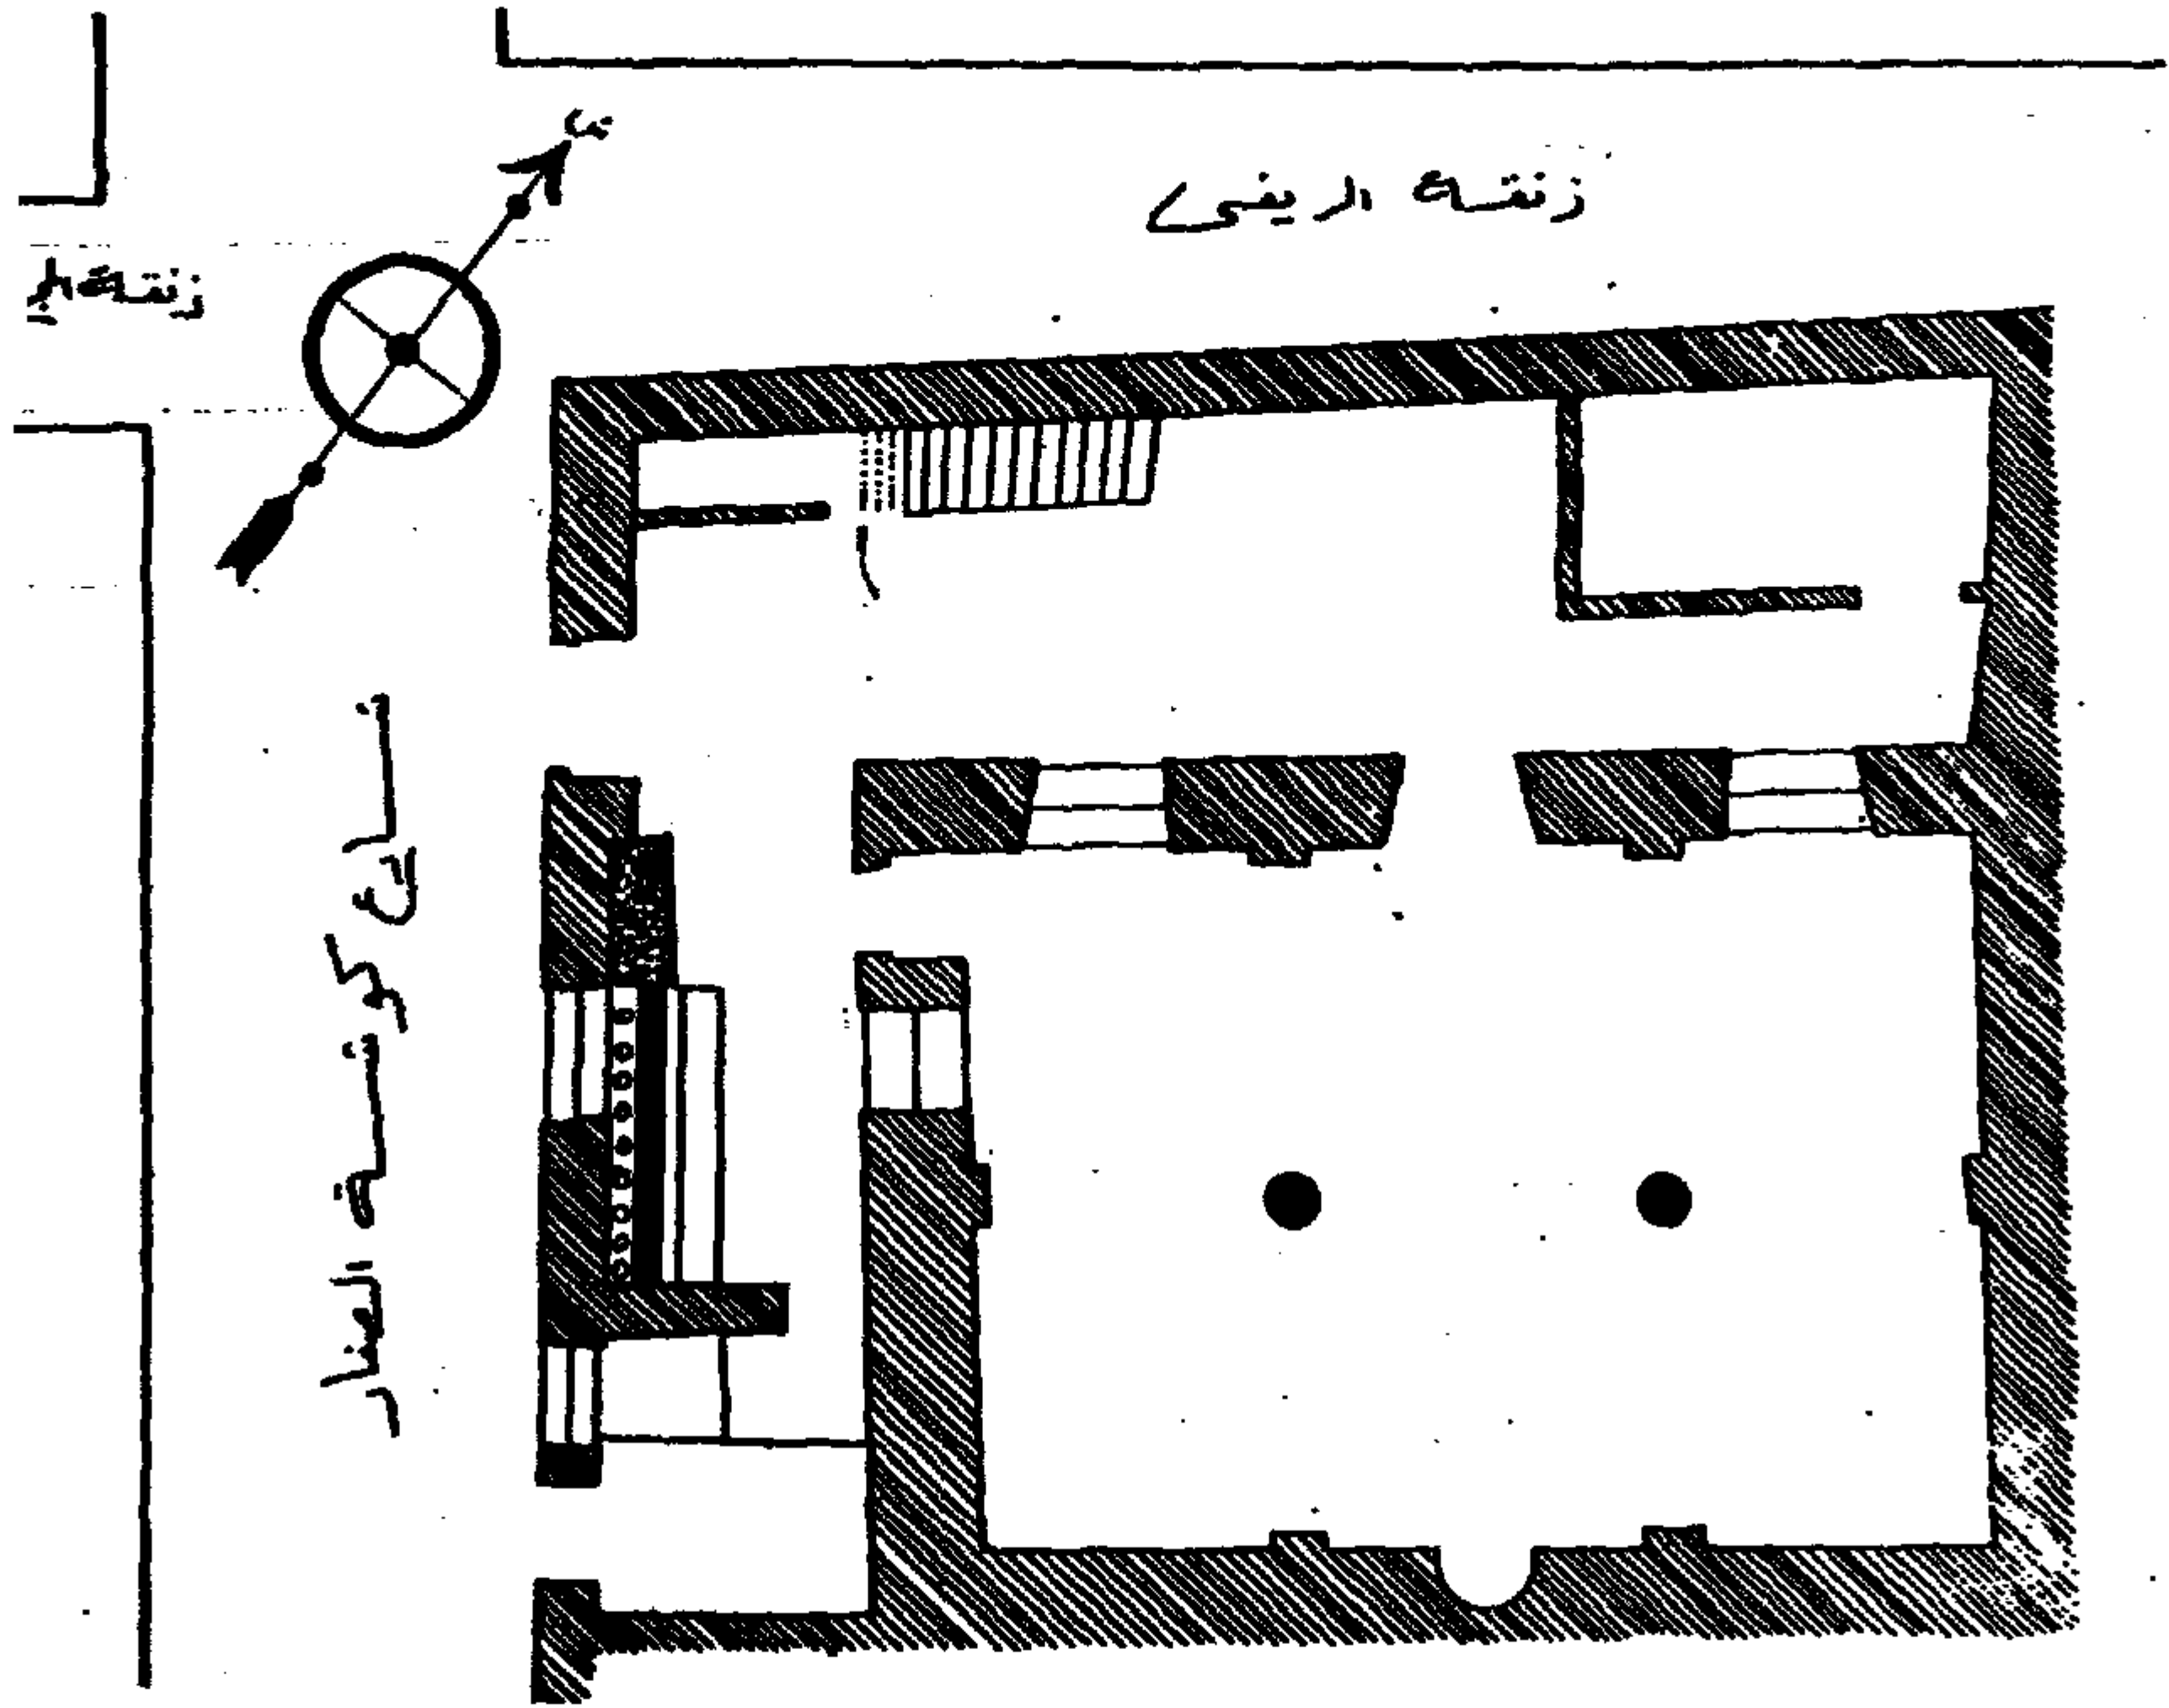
مسقط أفقي لمسجد الدوكالى عن موسوعة الآثار الإسلامية.
